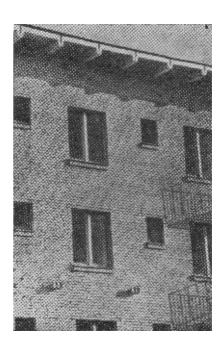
Фрагмент фасада дома с несущими кирпичными стенами (Новые Черемушки, Москва)
